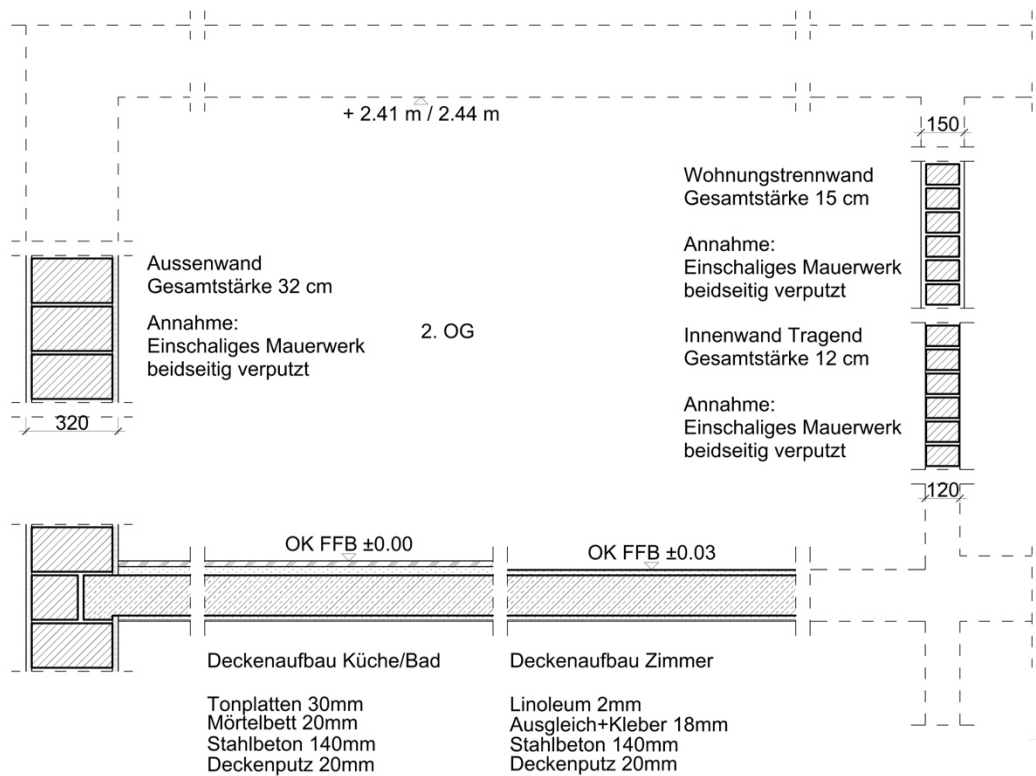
Detailzeichnung des Modellzimmers mit Stahlbetondecke, Quelle: Zeichnung INEB nach Informationen aus Bestandsunterlagen
